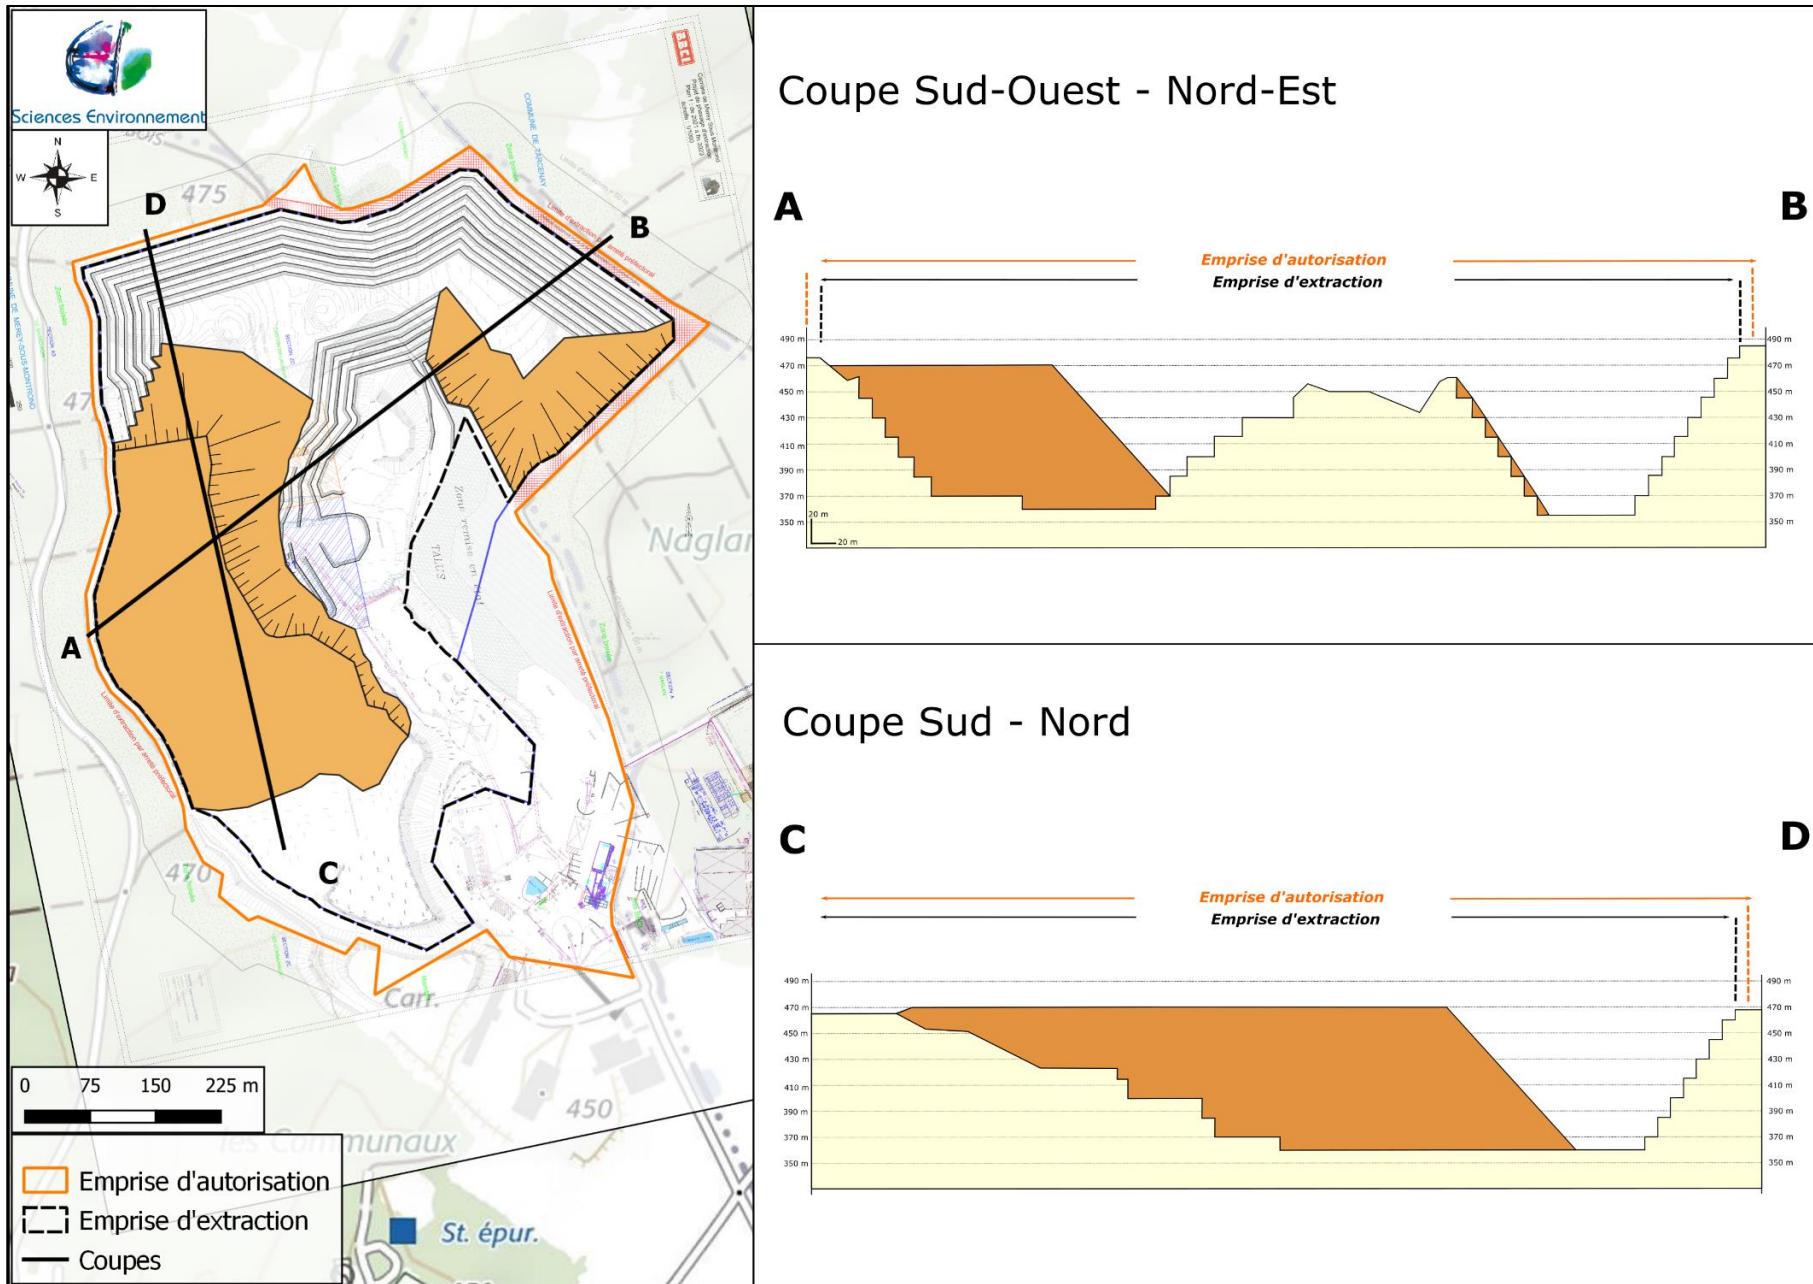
Coupes schématiques du site en fin d'extraction et de remblaiement
